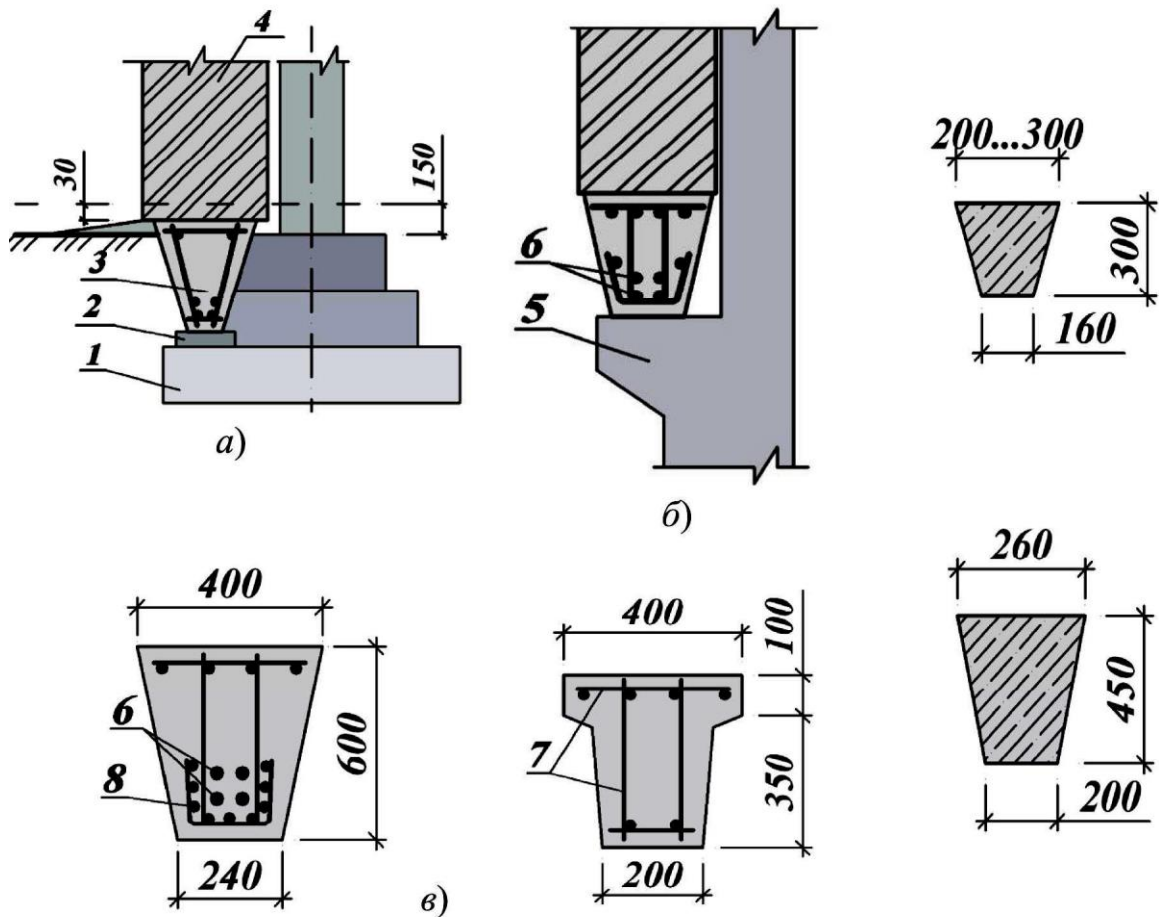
Фундаментні (а) та обв'язувальні (б) балки та їхні поперечні перерізи [6, 24]:
